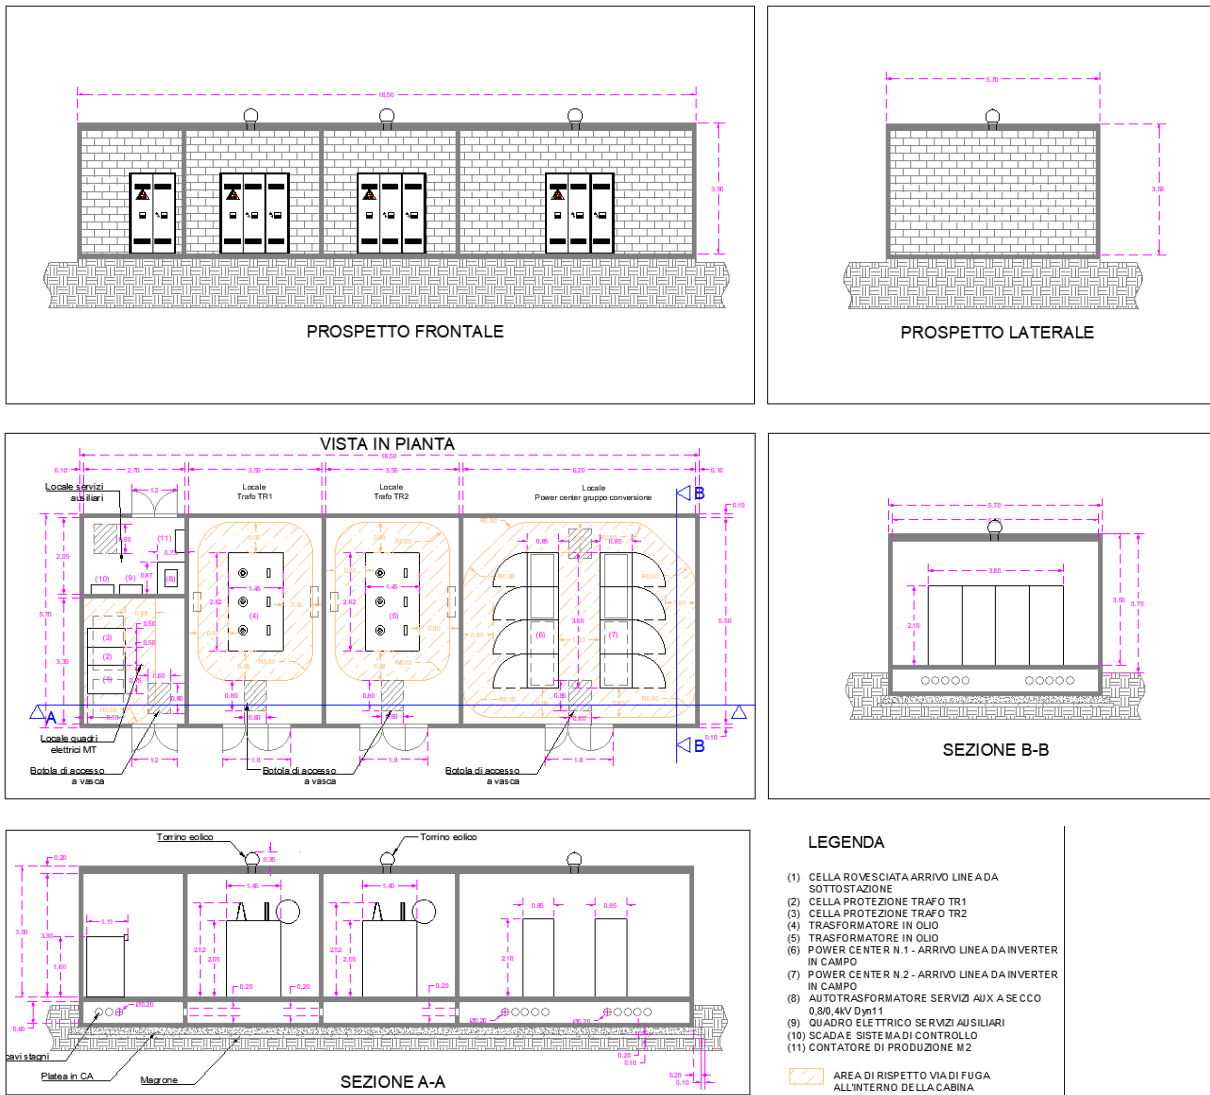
Pianta, sezioni e prospetti cabina di trasformazione (2 trafo)
